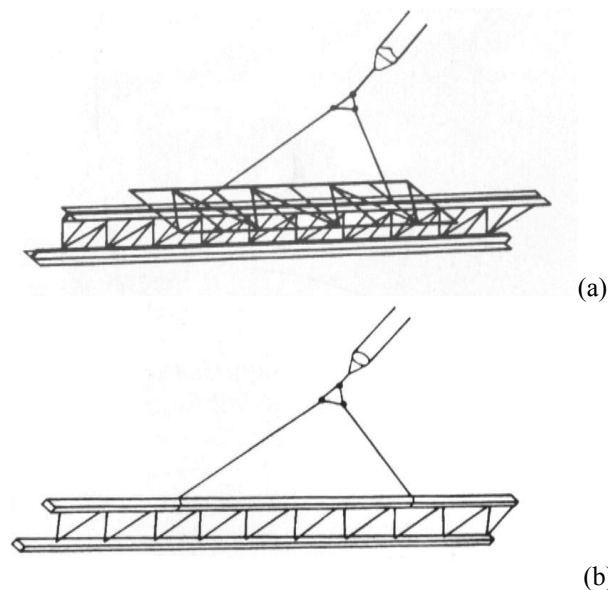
Içamento de vigas treliçadas: (a) viga treliçada de seções abertas com dispositivo de estabilização transversal ou cavelete de içamento; (b) viga transversal de seção tubular sem dispositivo especial para içamento
